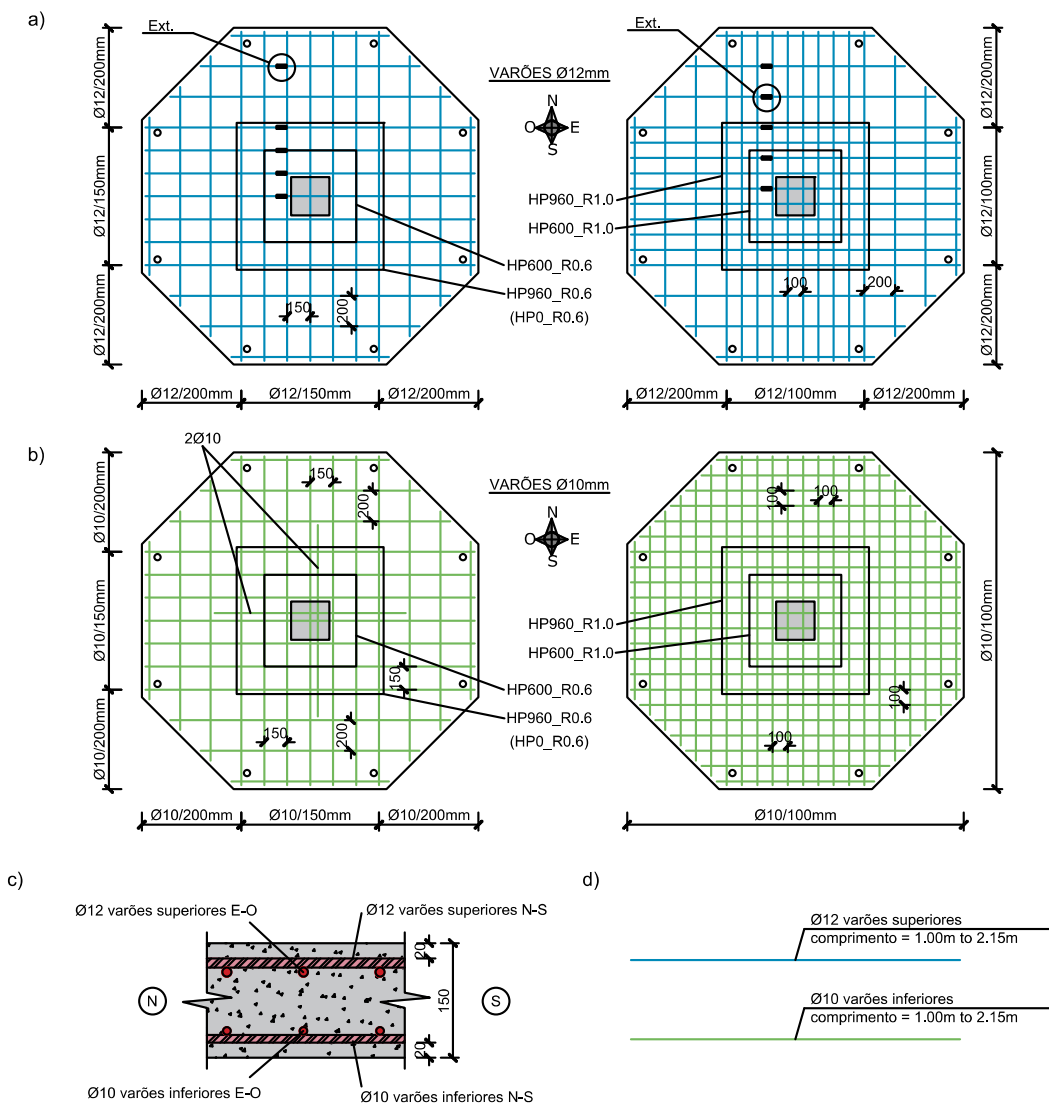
Armaduras de flexão: a) Armaduras superiores; b) armaduras inferiores; c) corte; d) pormenor da armadura.
